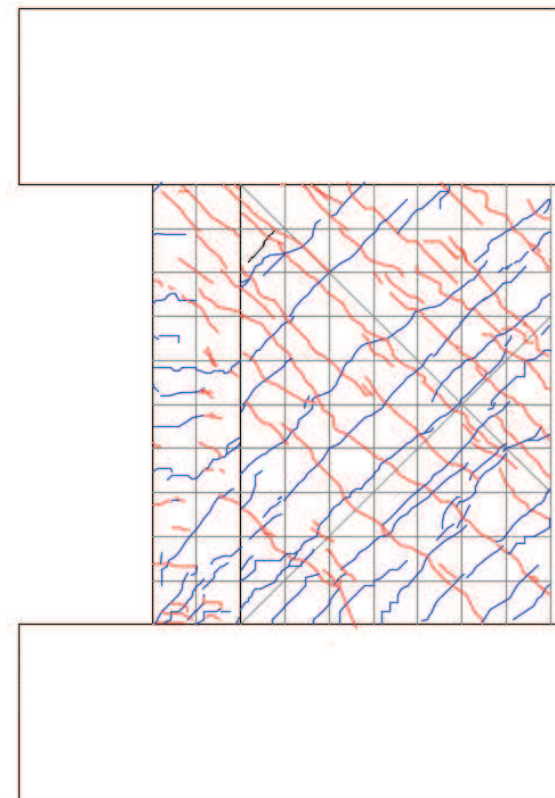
試験体 S-06-DIII 事前加力終了時 (4/1000rad.) ひび割れ図
